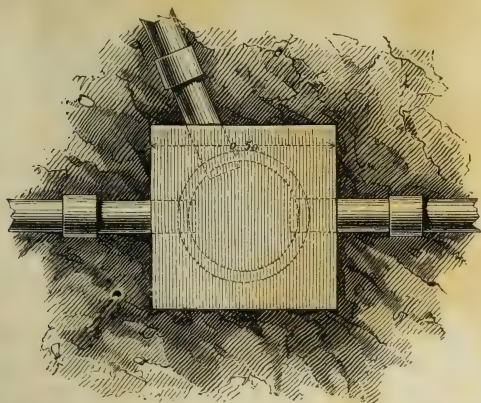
Plan d'un regard construit avec tuyaux à emboîtement.
